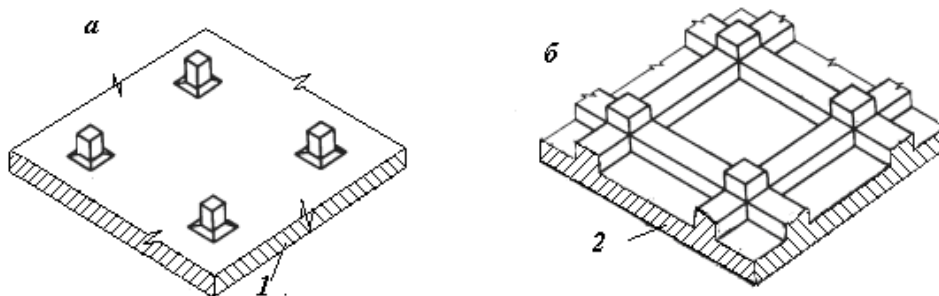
Суцільні фундаменти із монолітних залізобетонних плит: а – плоска (безбалочна); б – ребриста плита; 1 – суцільна плита; 2 – ребриста плита
